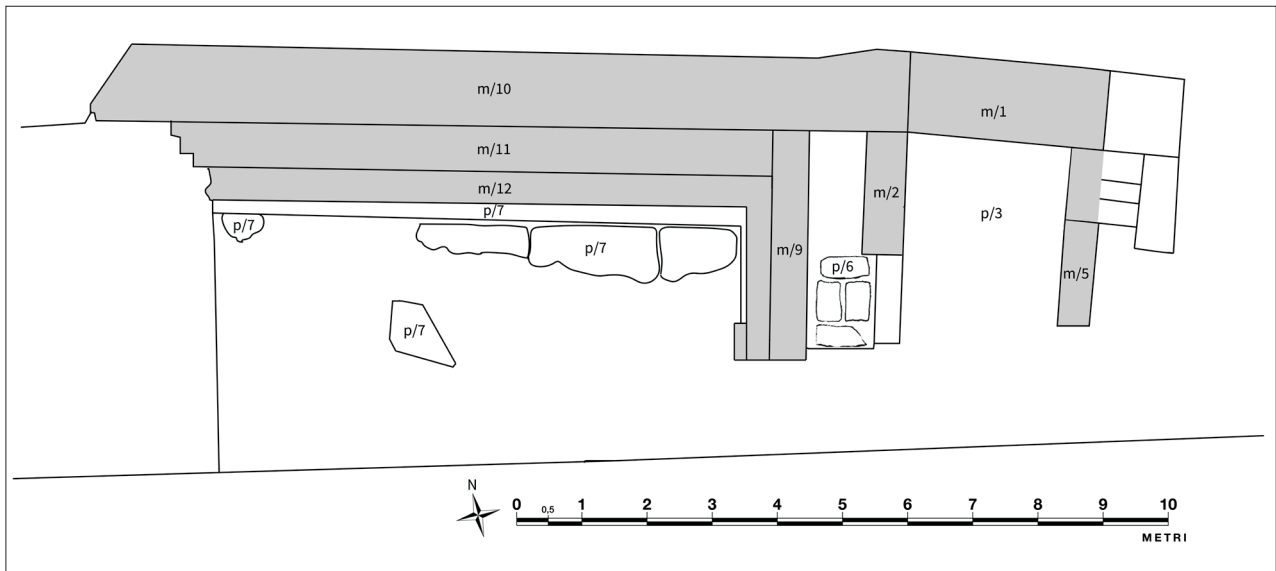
Pianta schematica delle strutture attribuite alla Fase costruttiva 3 dell'edificio
